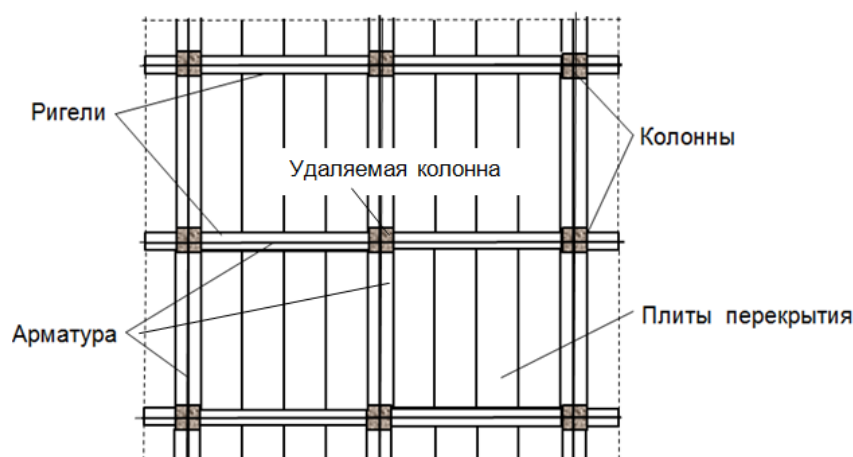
Конструктивная схема усиленного перекрытия здания со связевым каркасом
